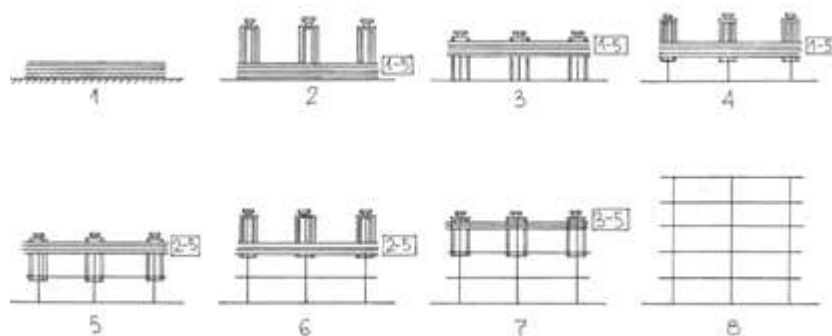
Принципова схема будівництва багатоповерхових будинків методом підйому пакета плит: 1 – бетонування всіх плит перекриття у пакеті; 2 – монтаж підйомного устаткування на тимчасових колонах; 3 – підйом пакета плит до проєктної позначки першого поверху та монтаж колон першого поверху; 4 – переміщення підвісного устаткування разом з тимчасовими колонами на нову позначку; 5 – підйом інших плит пакета до проєктної позначки другого поверху та монтаж колон другого поверху; 6 – переміщення підйомного устаткування до наступного рівня; 7 – подальше піднімання пакета плит тощо; 8 – завершення підйому, встановлення інших плит в проєктне положення і демонтаж підйомного устаткування
